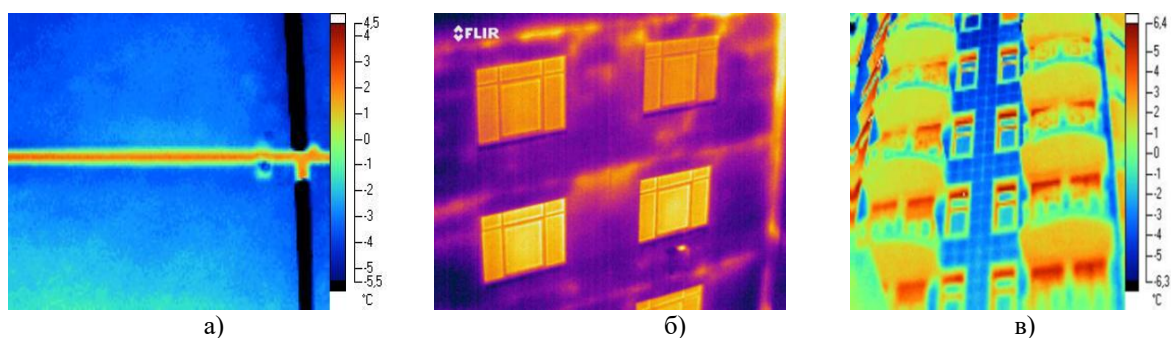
Термограми будівель з вентиляваним фасадом класу В.1:
